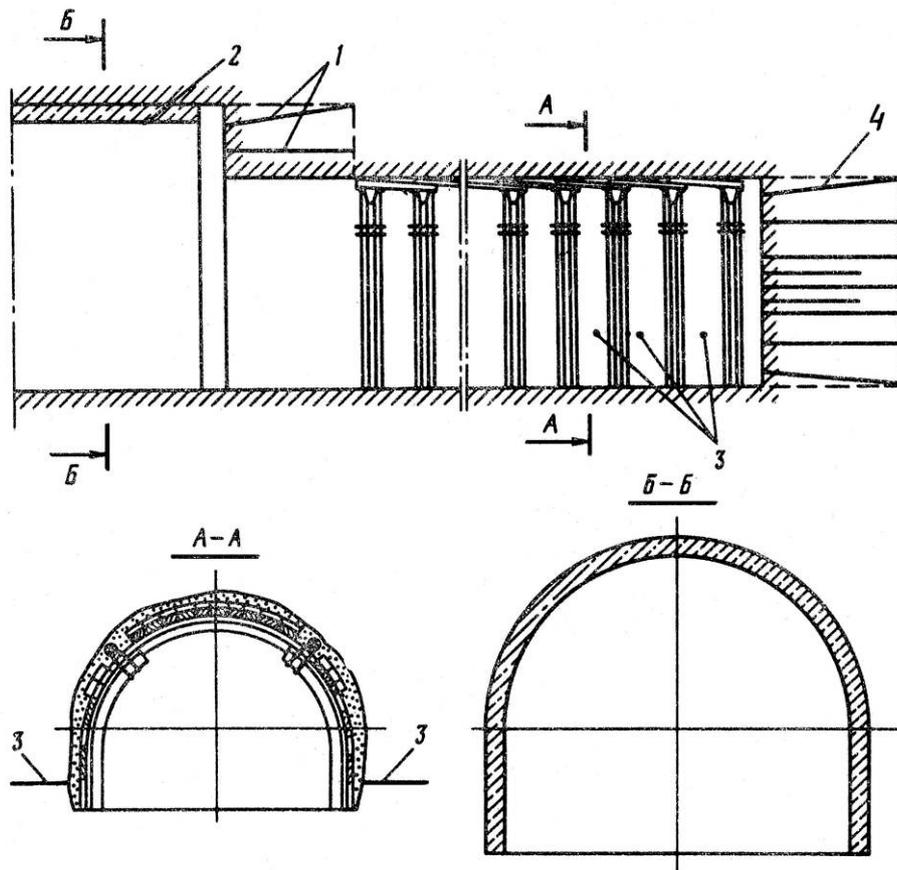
Комбинированный способ охраны капитальных выработок: 1 – шпуры для расширения передовой выработки до проектных размеров; 2 – выработка проектного сечения; 3 – разгрузочные шпуры; 4 – шпуры для проведения передовой выработки
